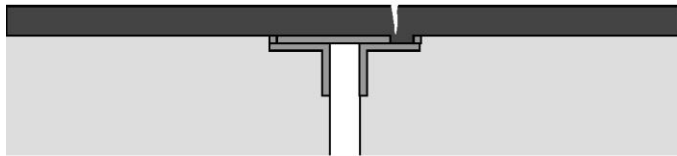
Tipo de junta de expansión placa de acero cubierta de asfalto
